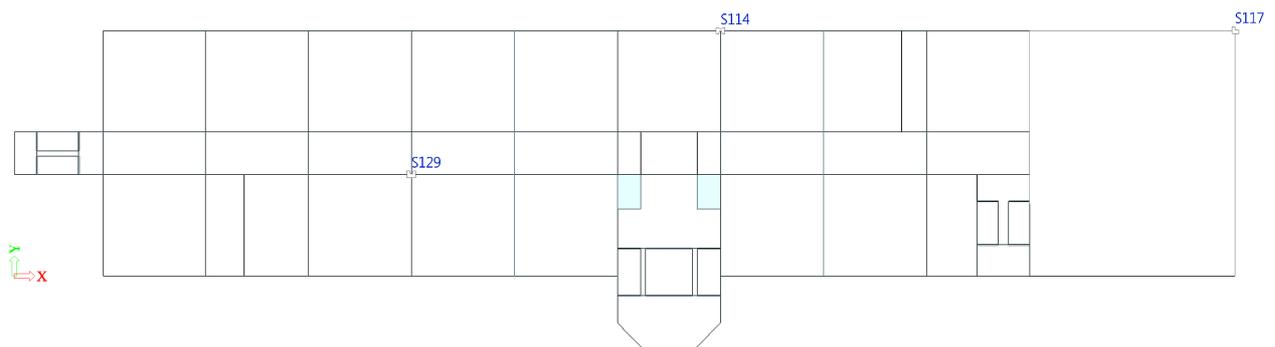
Grundriss Erdgeschoß - Position der maßgebenden Stützen
